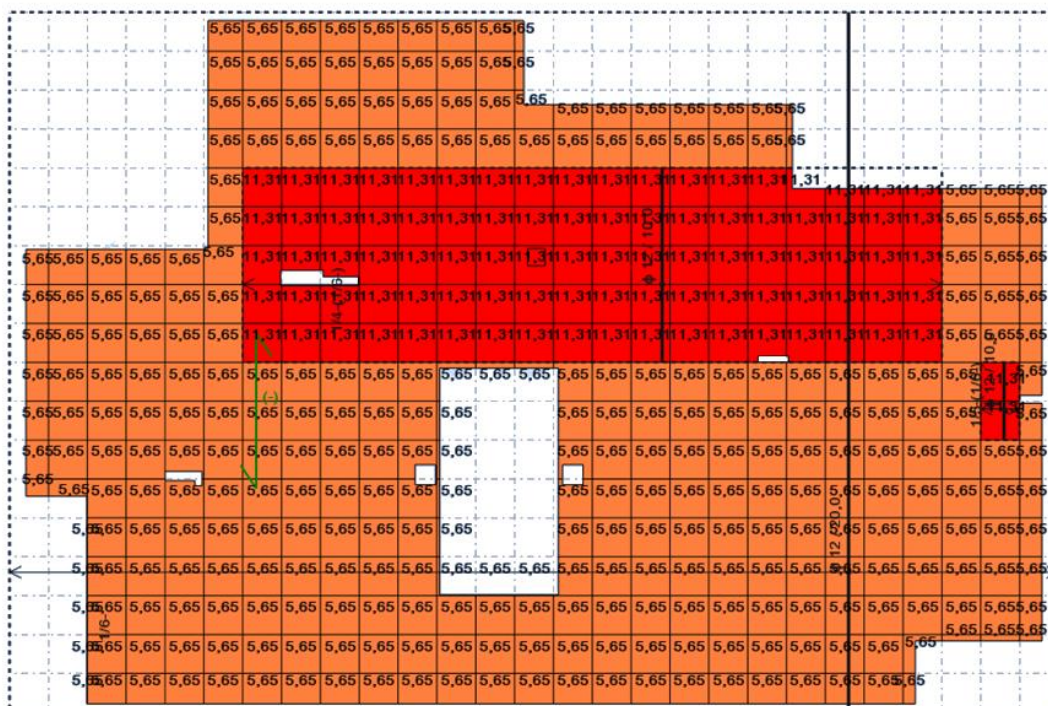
Solução de distribuição das armaduras inferiores paralelas ao lado menor da laje do piso 2
